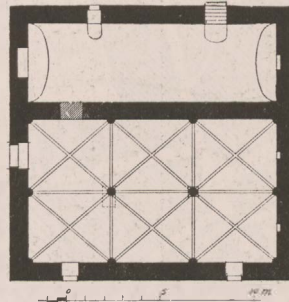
Grundriß des Schloßkellers zu Tiegenhof. Maßstab 1 : 400.
